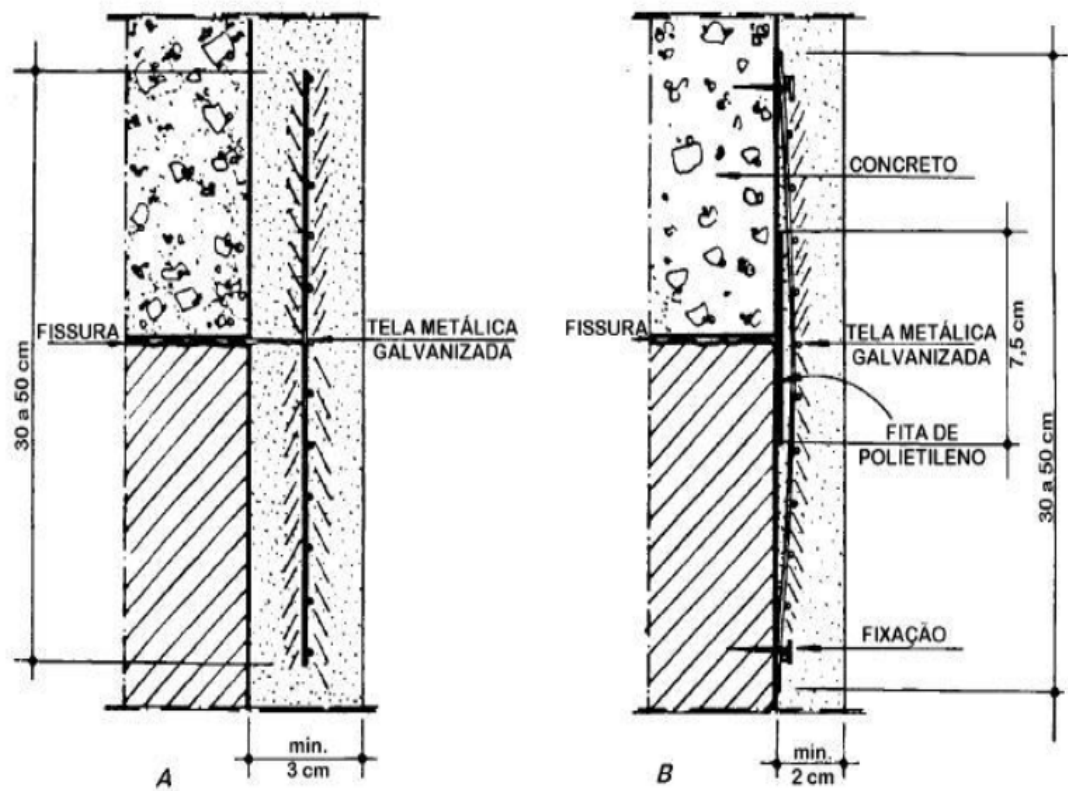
Aplicação de reboco armado (a) e ponte de transmissão (b)
